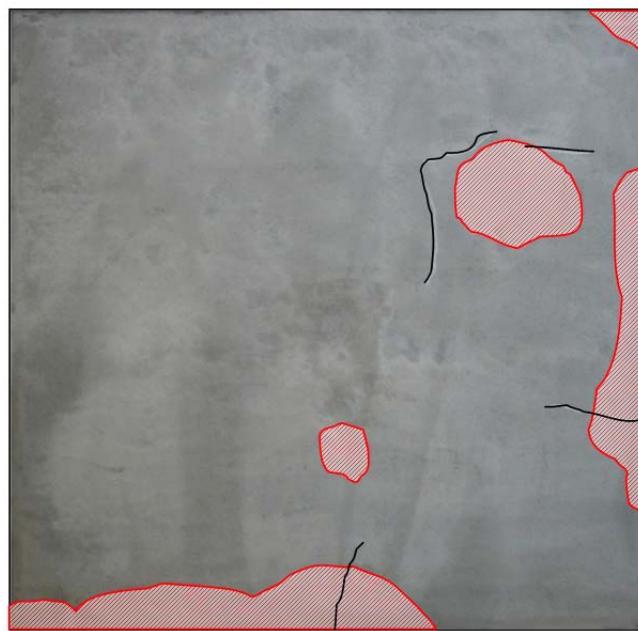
No. 3 浮き・ひび割れ発生状況[P7]
